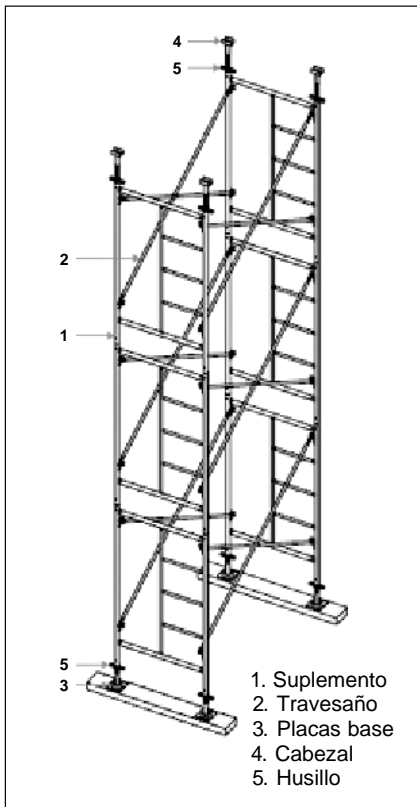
Cimbra ligera para edificación. Detalle de componentes.
